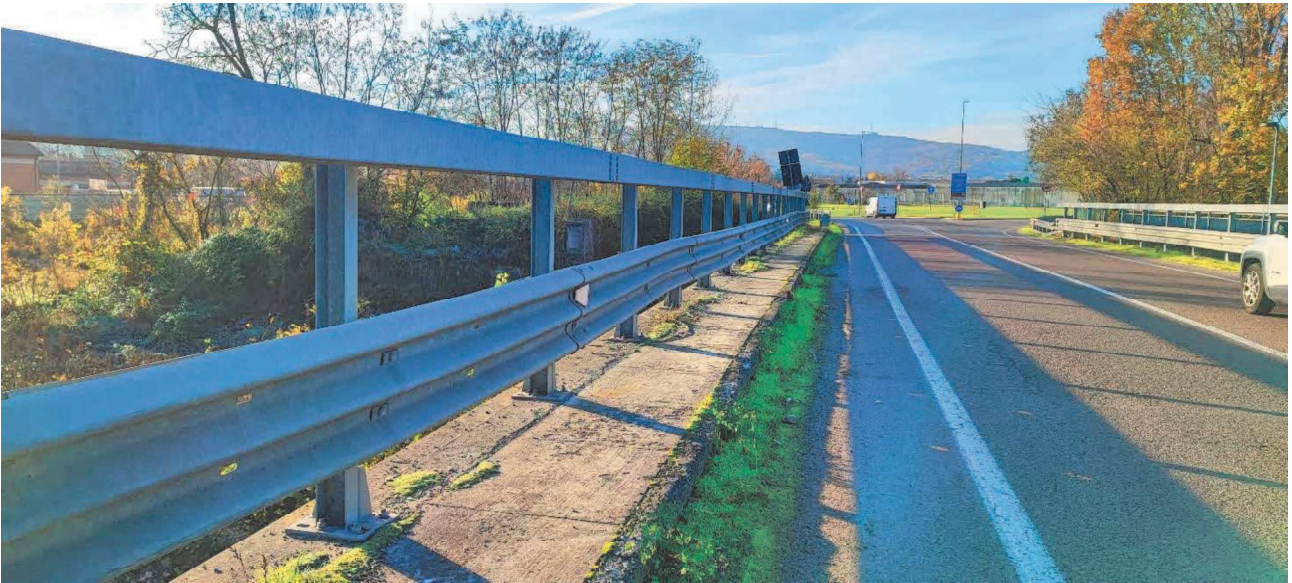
Giunto sotto pavimentazione lato Rubiera. È prevista la sostituzione con un giunto a pettine analogo a quello posizionato lato Scandiano
